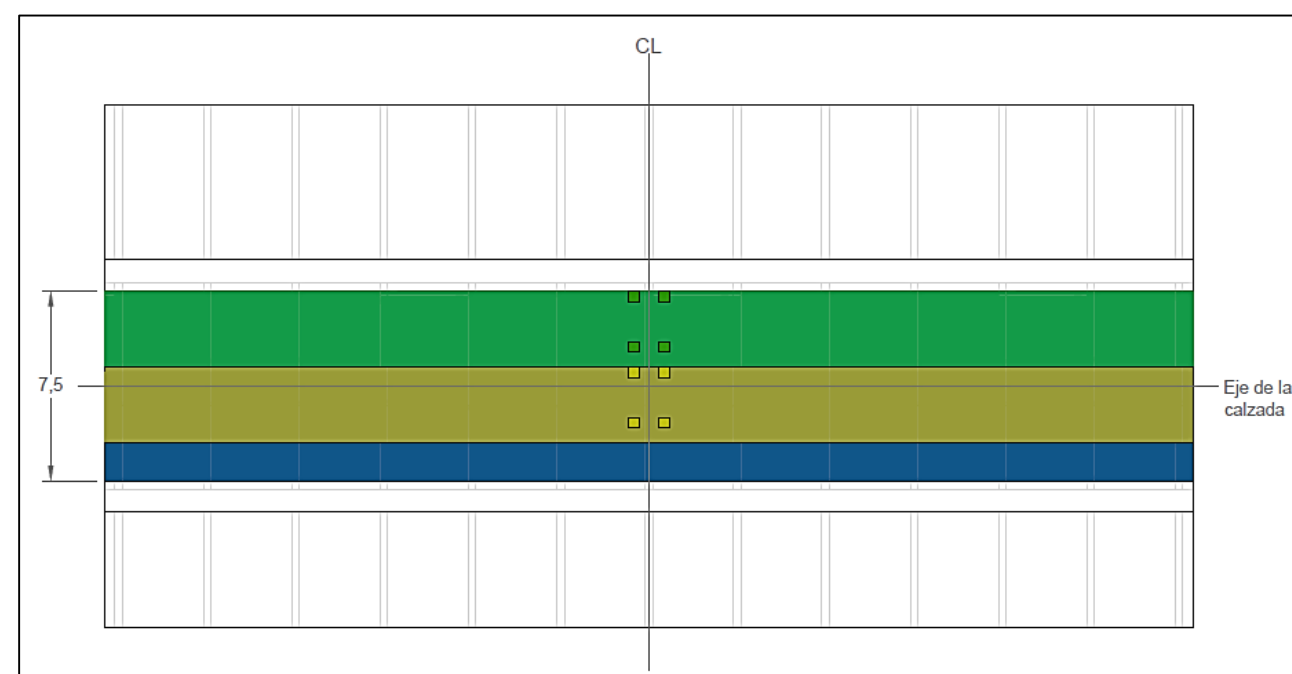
Caso 3 de sobrecargas de uso – Planta. Elaboración propia con AutoCAD
